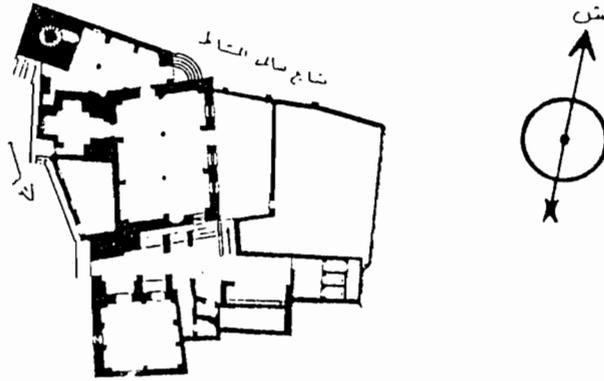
مسقط أفقي لمسجد ميفارقين عن أصلان آبا.
